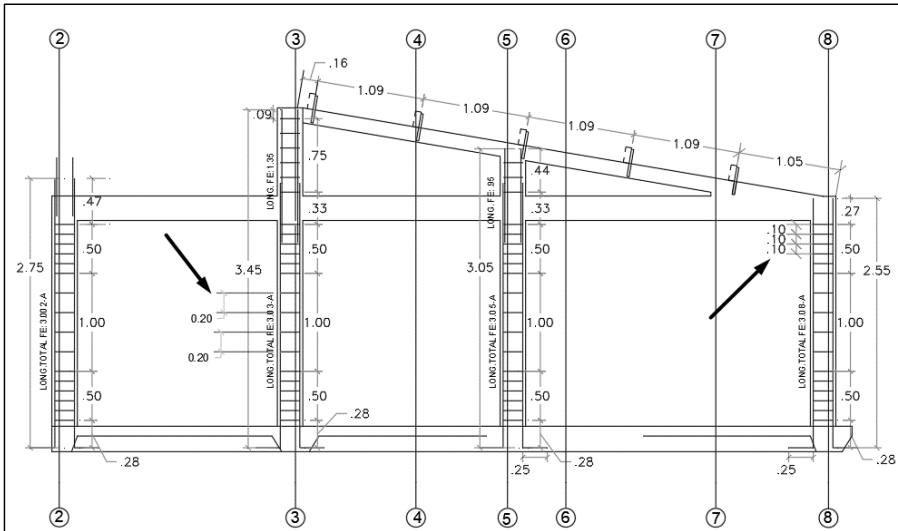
Planta de la distancia entre columnas de confinamiento.
